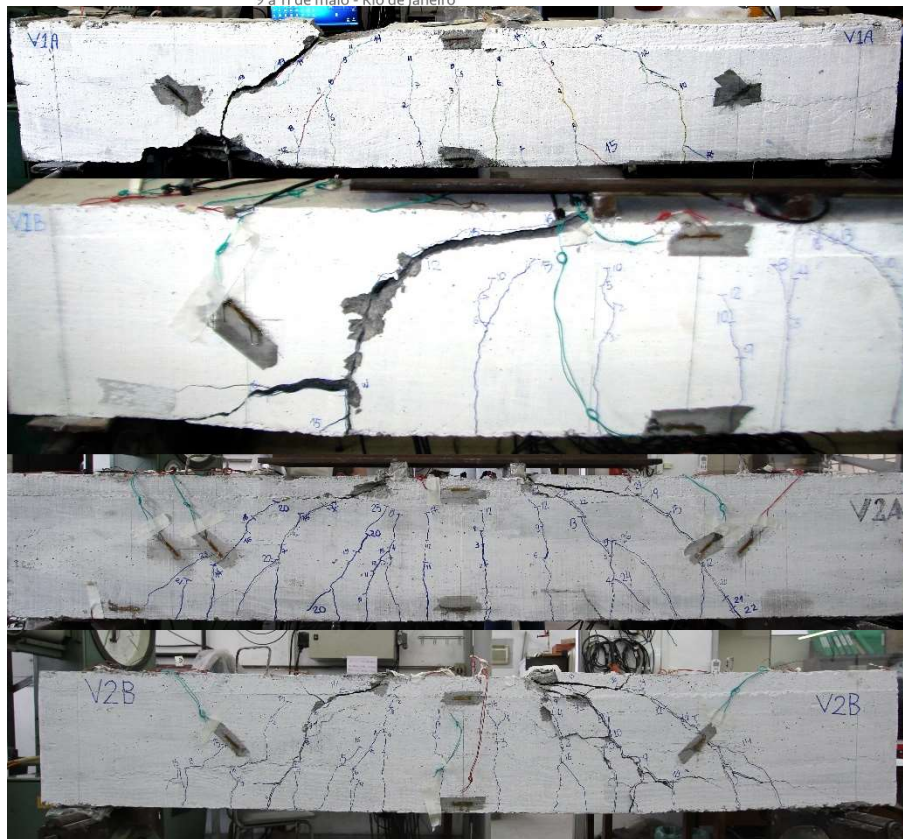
de cima para baixo: Padrão de fissuração e ruptura dos modelos V1A, V1B, V2A e V2B
